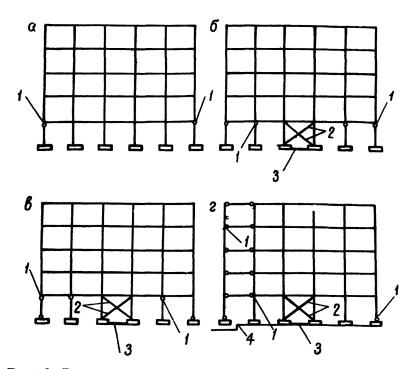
Расчетные схемы рам многоэтажных каркасных зданий с преобразованными уэлами;
